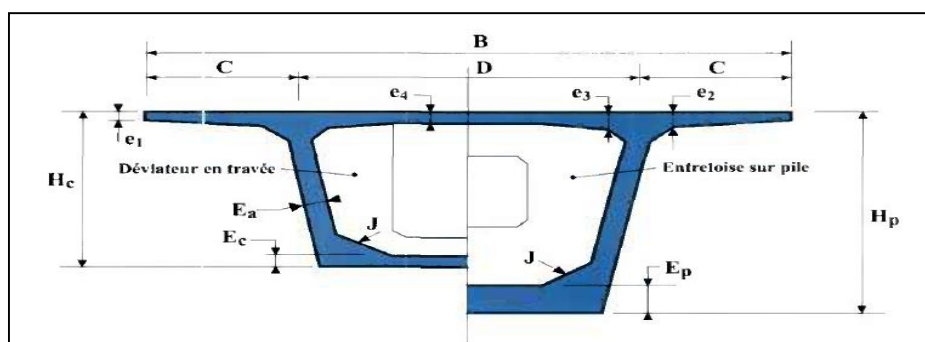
Définitions des dimensions de la section caisson (SETRA, p38)
